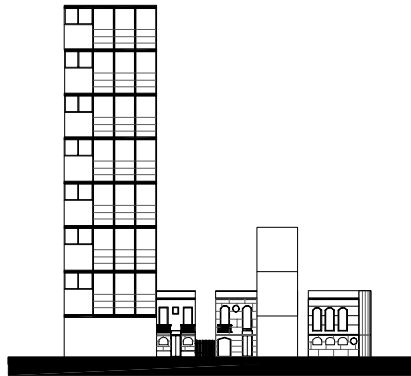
Perfil urbano de la Calle Río de Janeiro.
